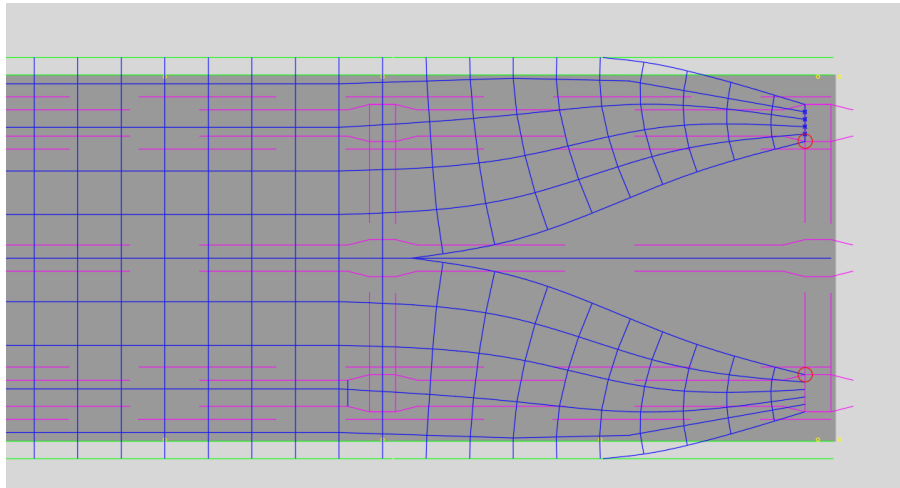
Vista en planta de la difusión de los esfuerzos de tracción provenientes de la diagonal hacia la sección total del tablero
